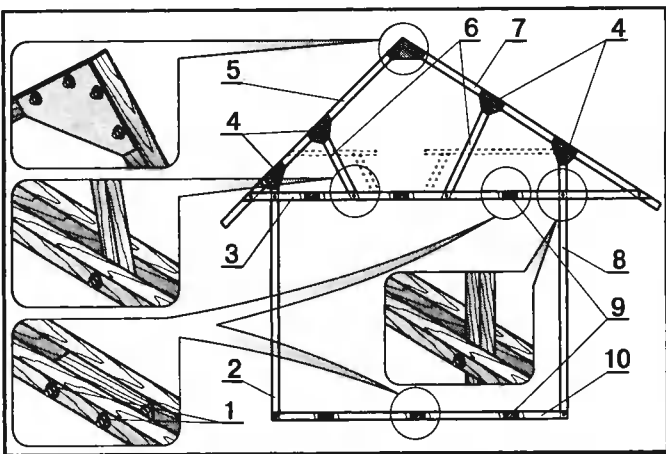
Ферма внутреннего каркаса домика (пунктиром показано ограждение только для фермы №3):
